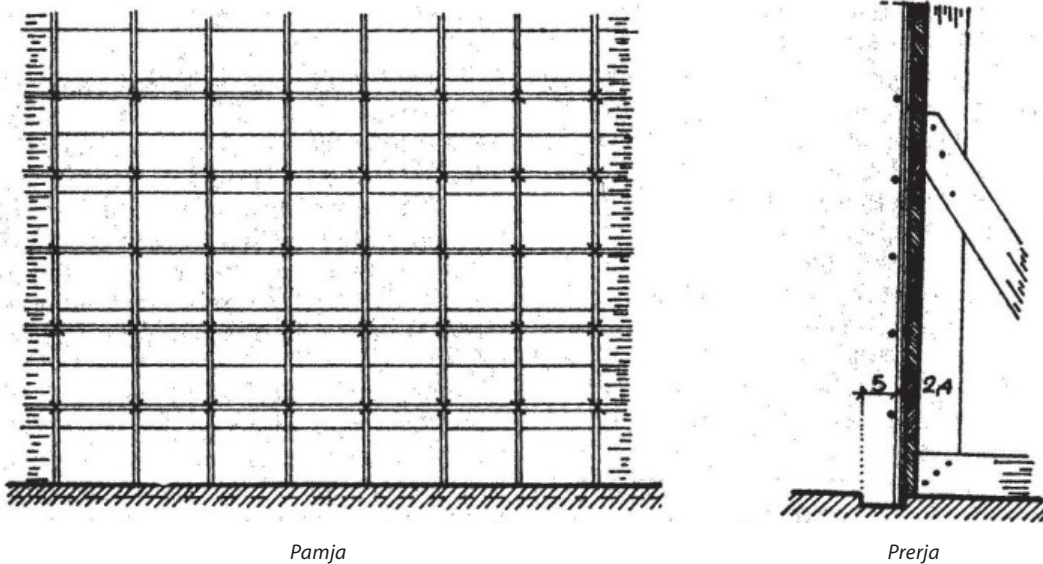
Mur me beton-arme me kallëpe njëanëshe
